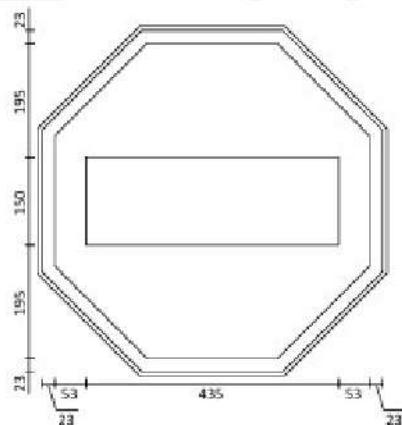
Placa SIGA para procedimento “PARE e SIGA”
